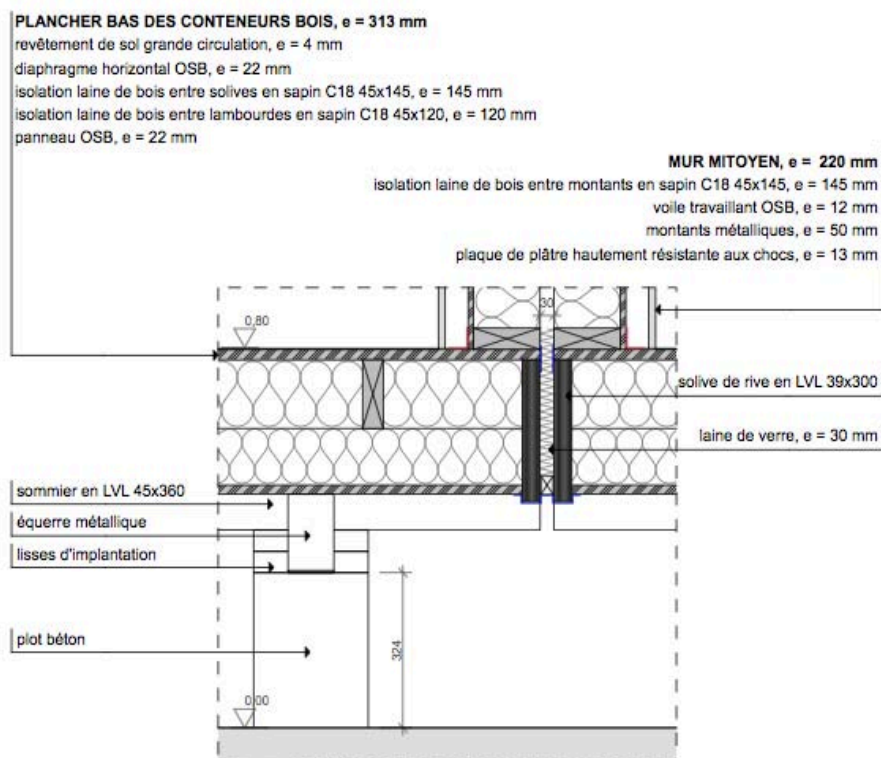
Fixation du sommier LVL sur les plots béton - échelle 1/20
